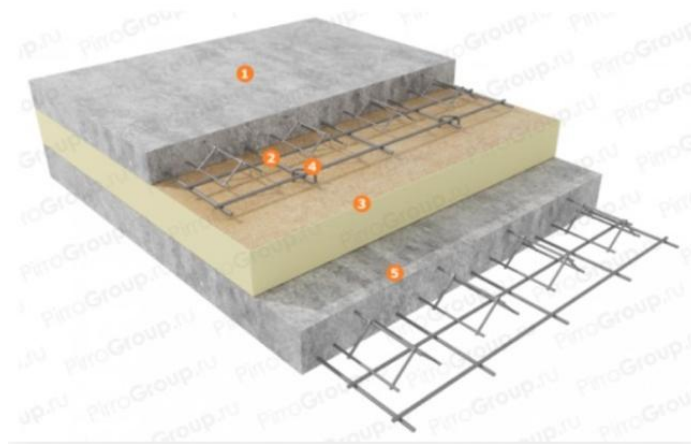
Розріз тришарової залізобетонної панелі (1, 2 - зовнішній шар залізобетону, 3 - шар утеплювача, 4 - зв'язки залізобетону, 5 - внутрішній шар залізобетону)
